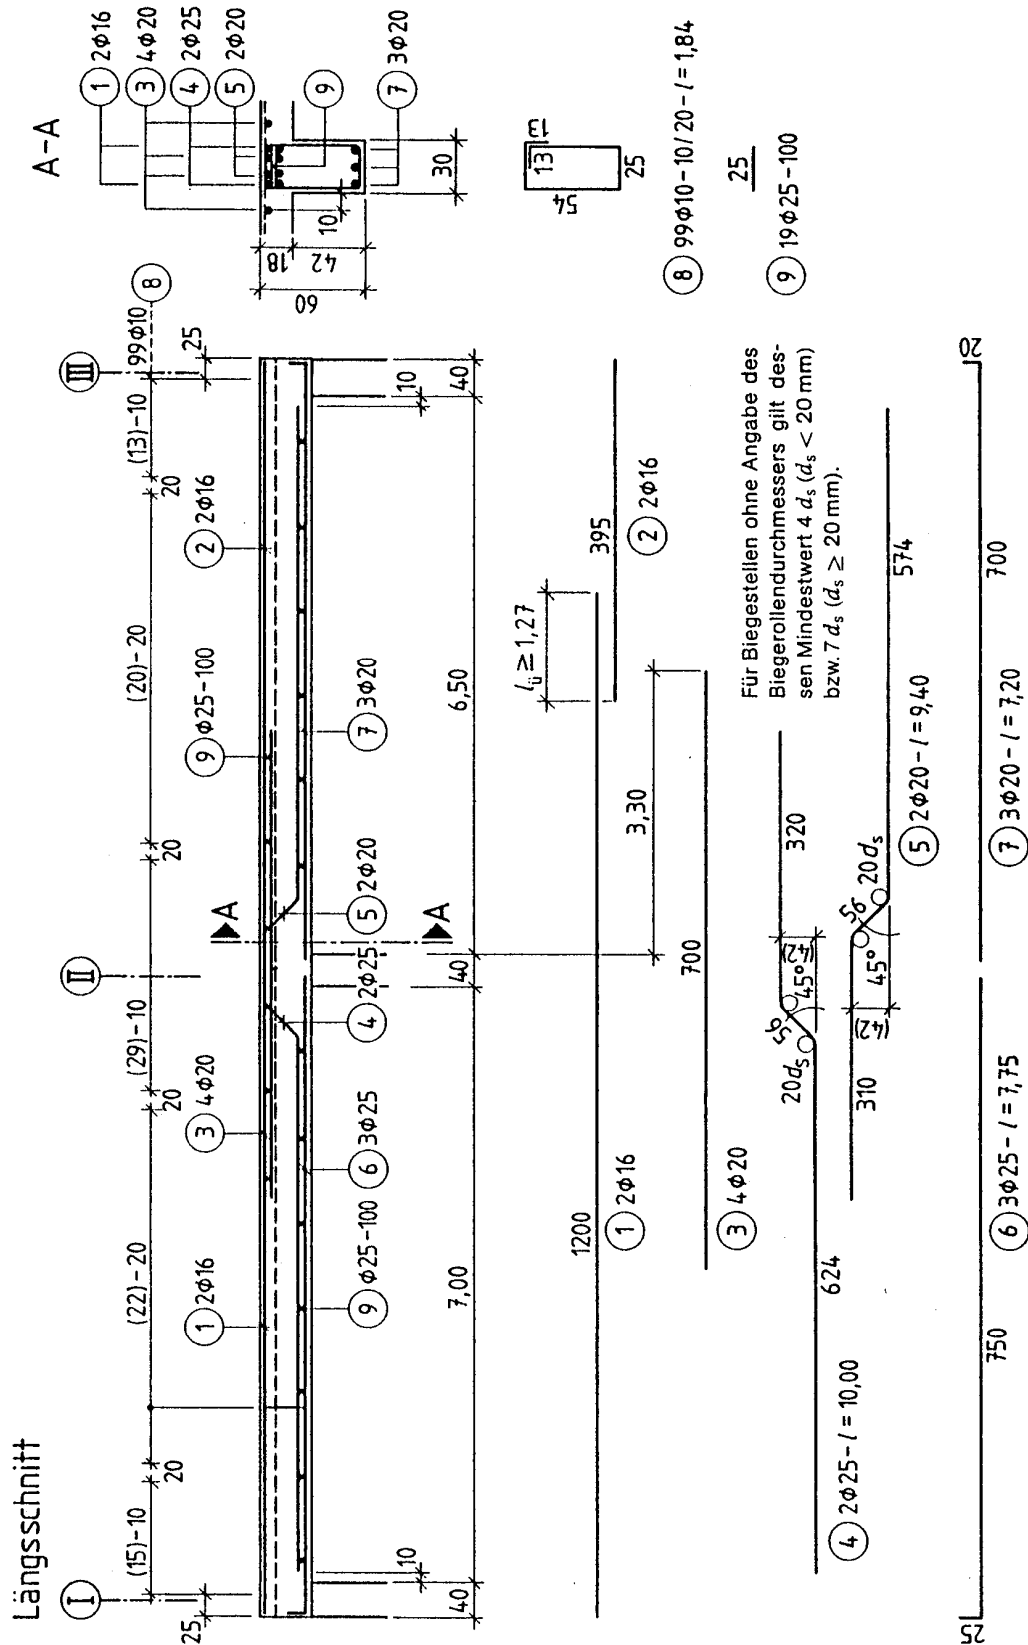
Bewehrungsplan für einen Stahlbetonunterzug (Darstellungsart 1)
